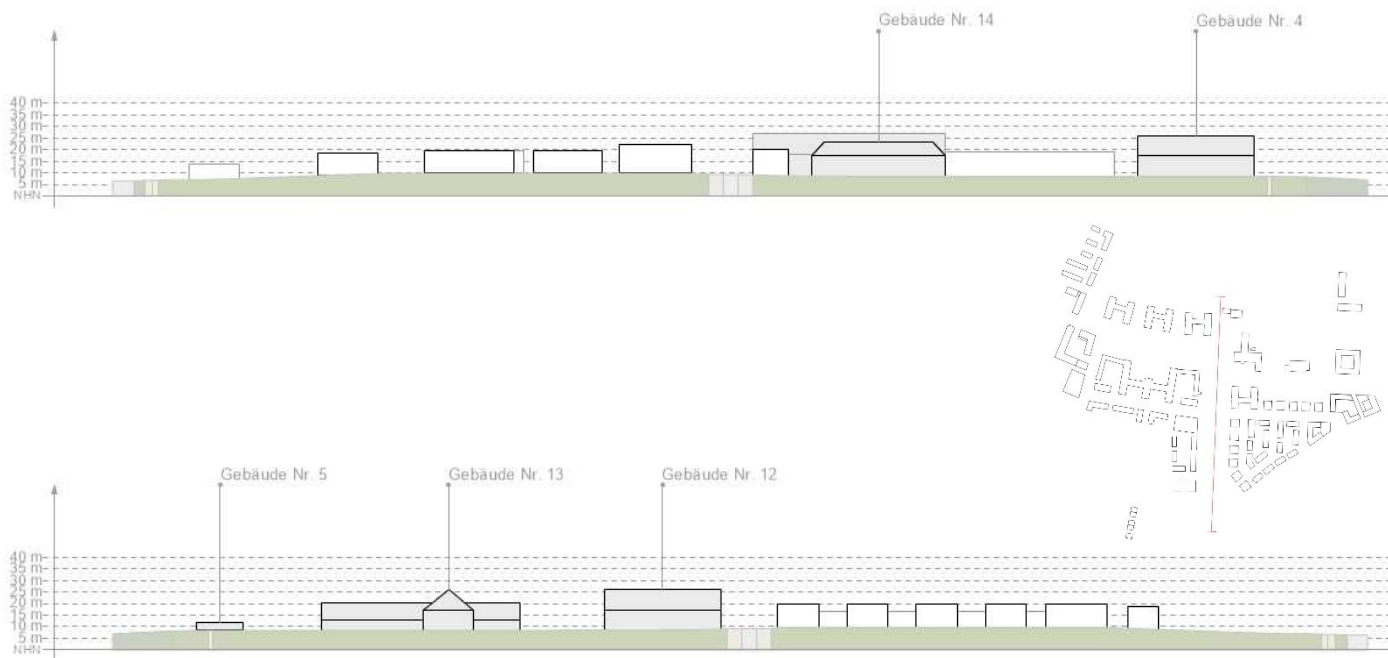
Quartierschnitte mit Verortung im Lageplan
